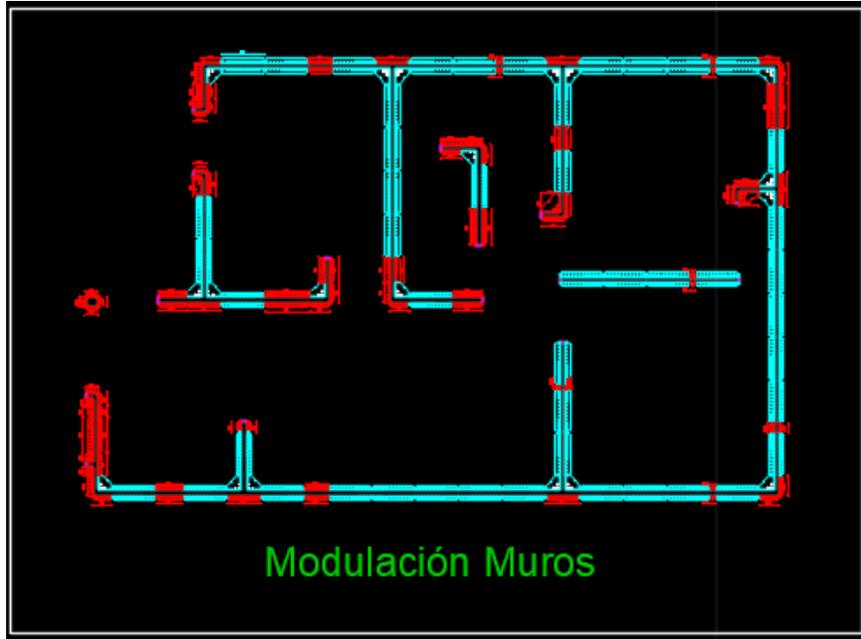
Modulación de formaleta para Muros proyecto a cargo de Constructora RM.
